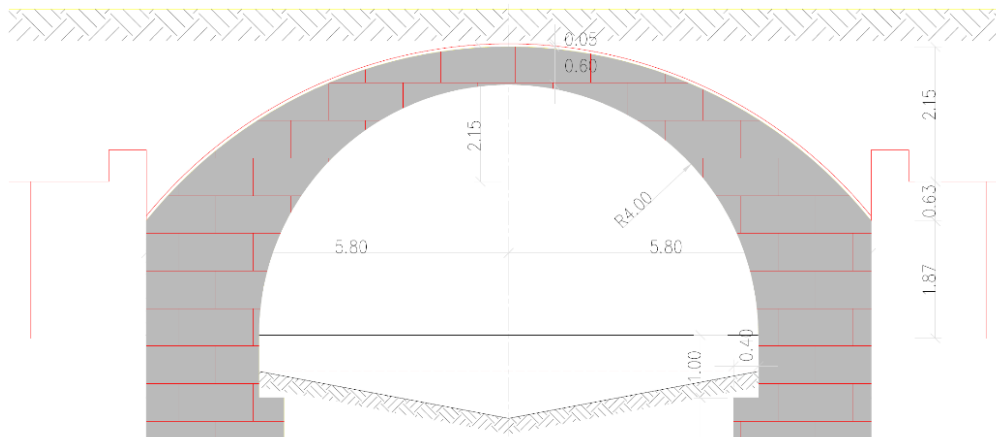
Secção tipo do caneiro no cruzamento com o traçado (levantamento - Projeto túnel ferroviário)
